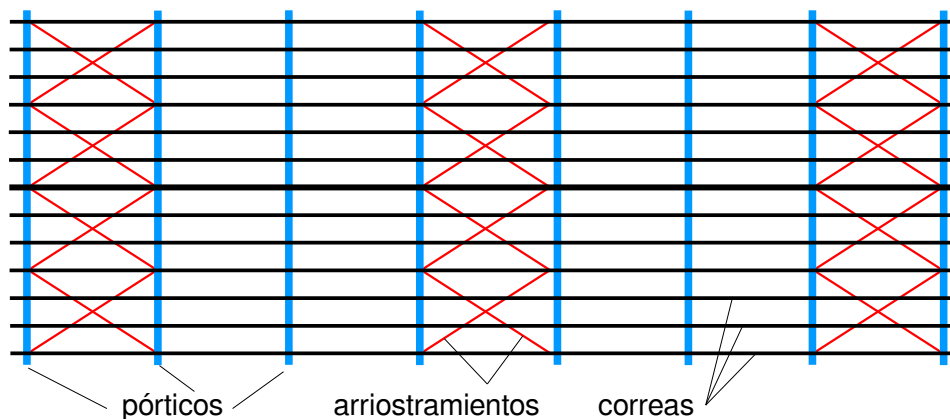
Vista en planta de la cubierta de una nave industrial: arriostramientos en el plano del faldón.
